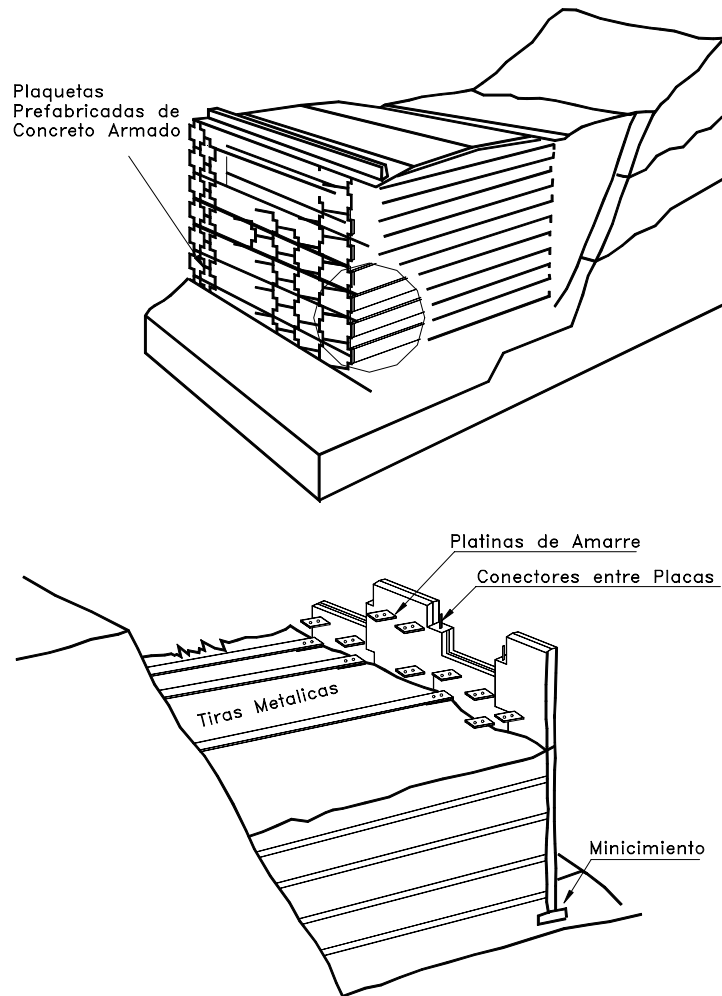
Muro de tierra armada con refuerzo de tiras metálicas.
